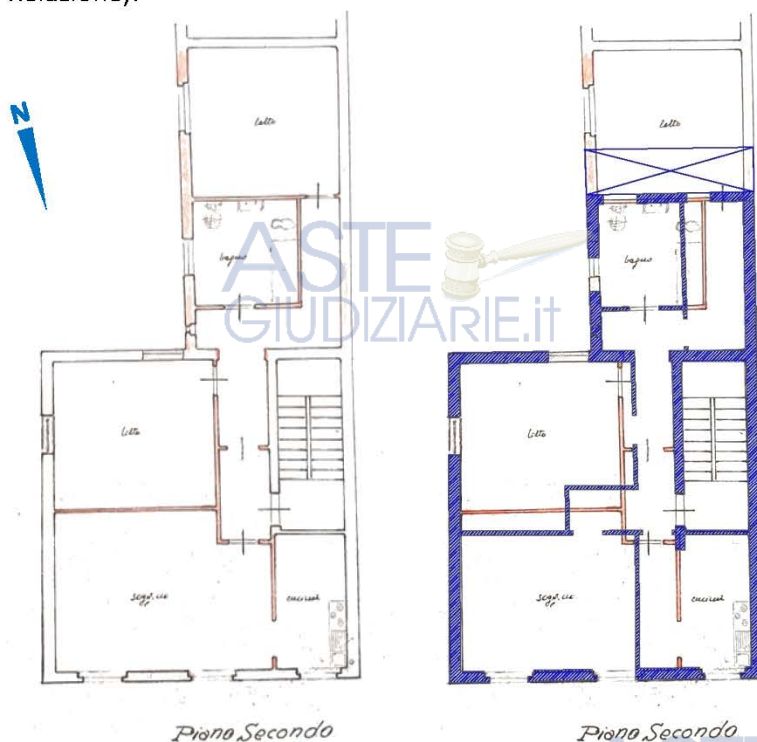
Planimetria di progetto (sinistra) e sovrapposizione in tratteggio blu con quanto rilevato in sede di sopralluogo (destra)
